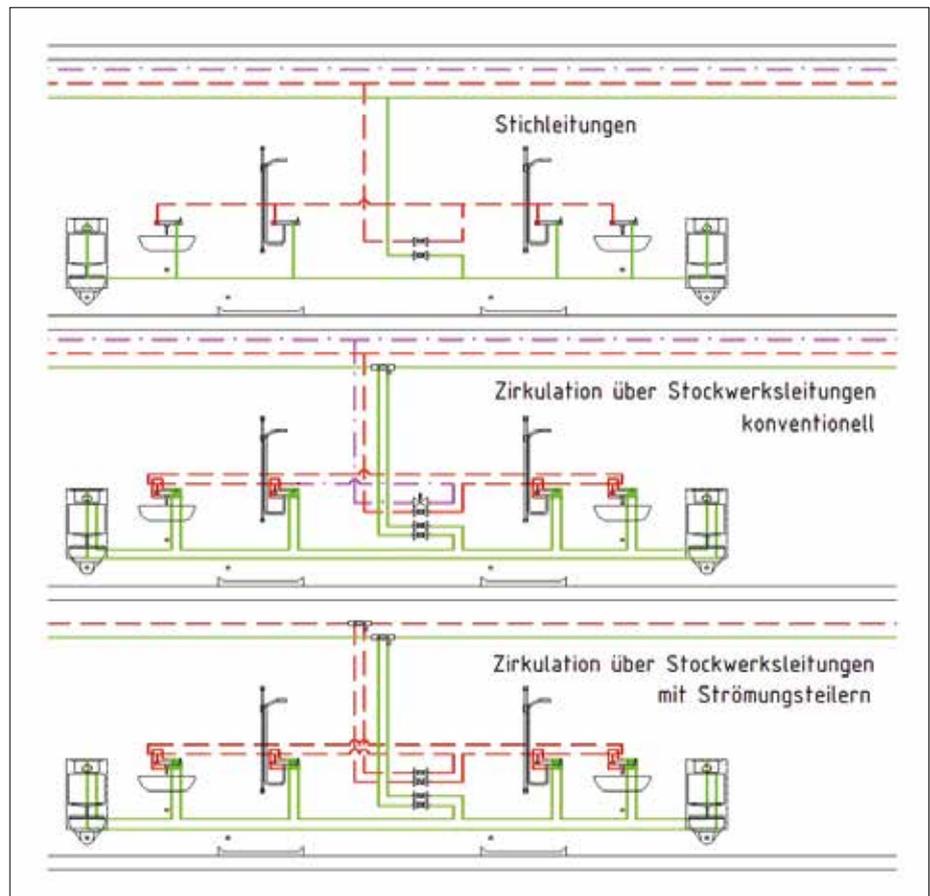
Stockwerksinstallationen für Zweckgebäude
